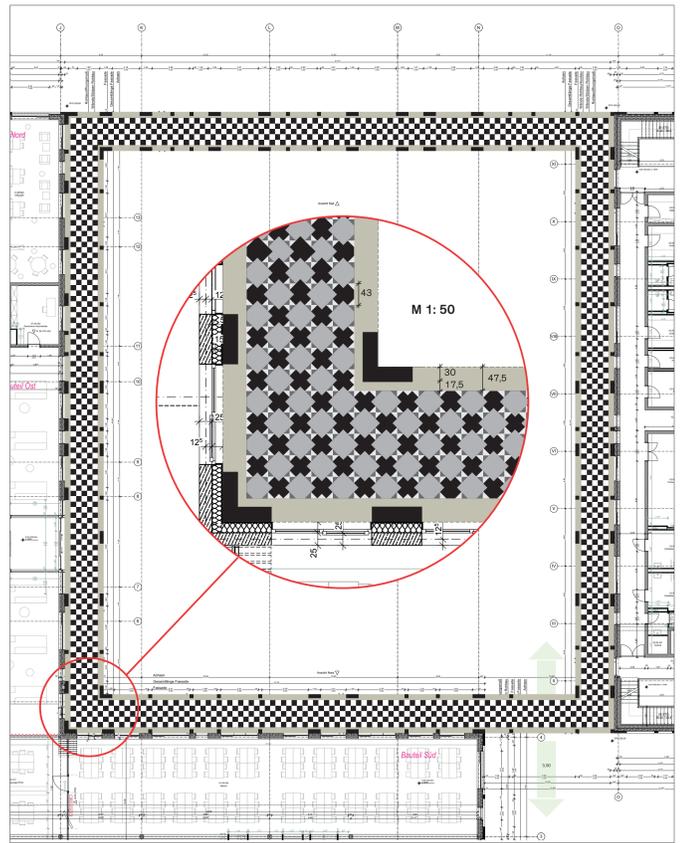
Lageplan mit Bearbeitungsbereich M 1:200
